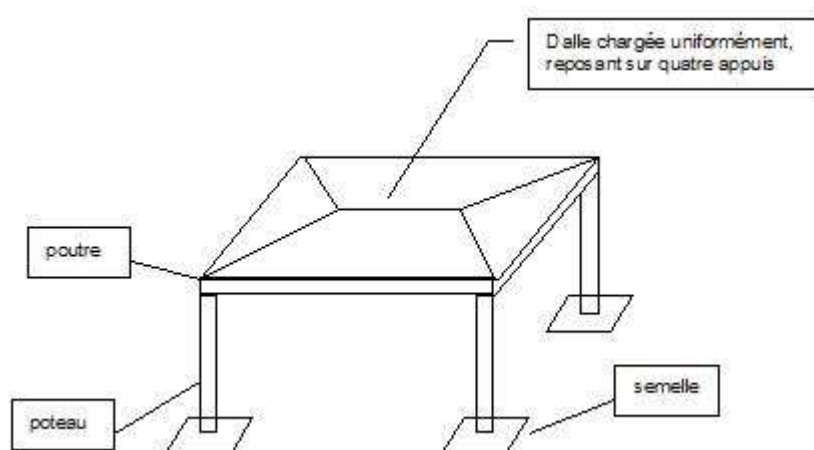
Cas d'une dalle reposant sur appuis.
